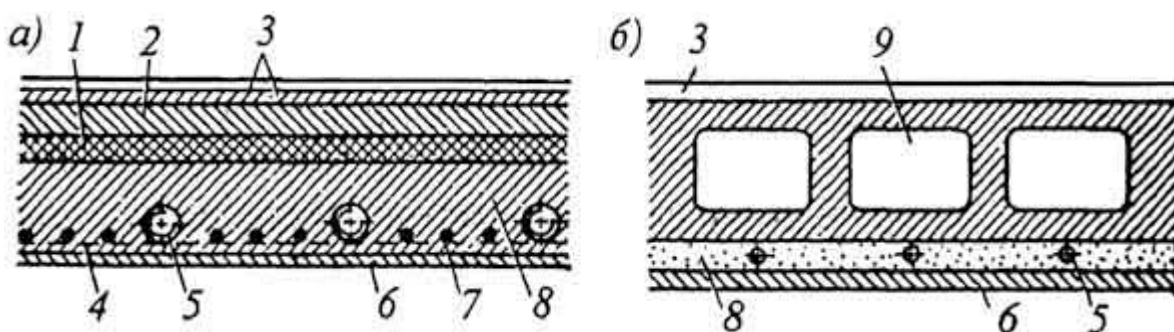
Совмещенные потолочные бетонные панели: *а* - с расположением греющих труб в несущем бетонном слое; *б* - то же под несущими пустотелыми блоками; 1 - теплоизоляция; 2 - цементная стяжка; 3 - покрытие пола; 4 - сетка; 5 - греющая труба; 6 - штукатурка; 7 - арматура; 8 - бетонный слой; 9 - пустотелая панель перекрытия
